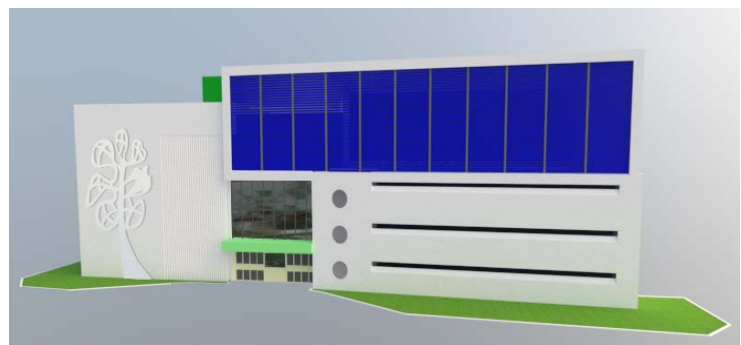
Modelo 3D renderizado da fachada norte com termobrisas do colégio base para a pesquisa.
